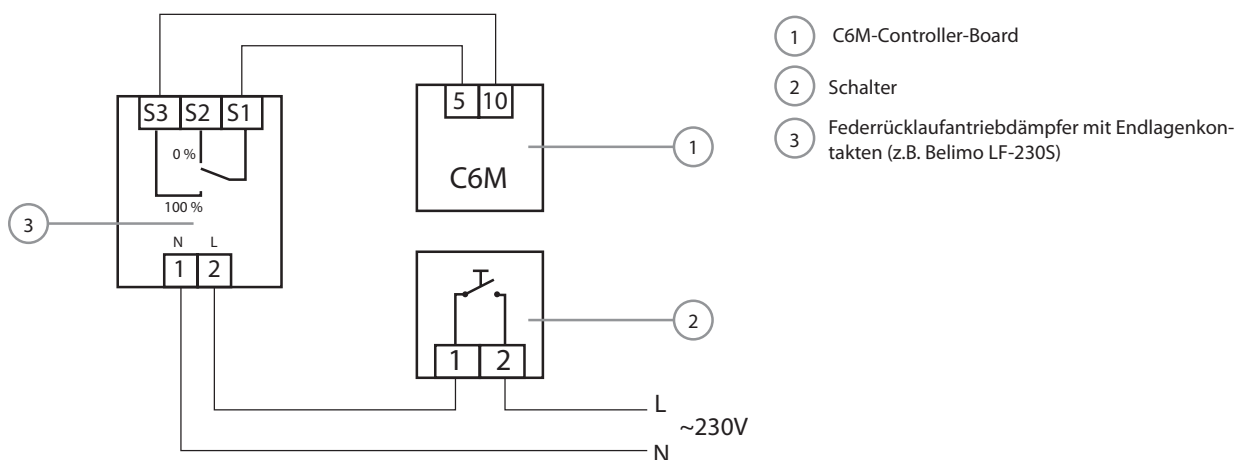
Beispiel für die Aktivierung des Lüftungsmodus „Übersteuerung“ bei Verwendung einer zusätzlichen Absaugung mit einer motorisierten Klappe (siehe Abb. 9).
